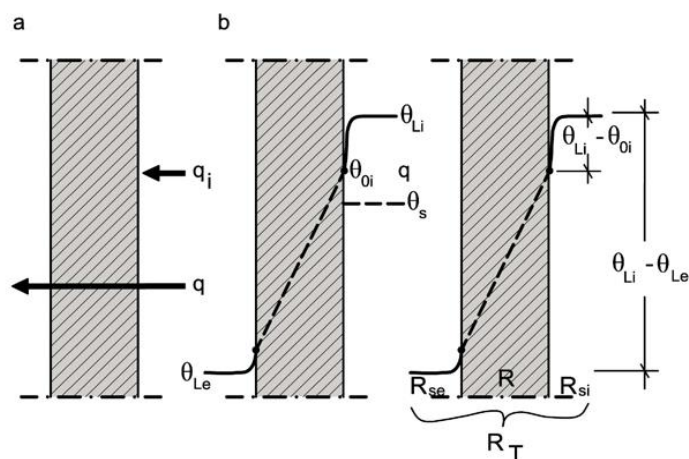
Außenbauteil a) Wärmeübergang q_i und Wärmedurchgang q , b) Temperaturverlauf θ im Bereich der Bauteiloberflächen
